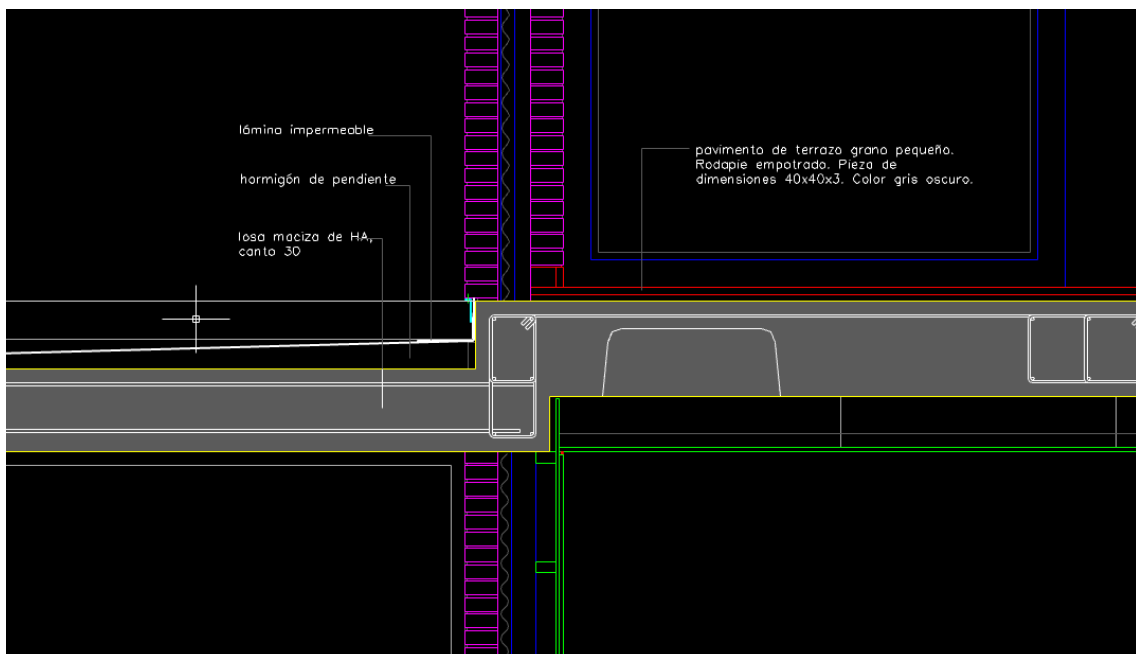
Forjado techo de planta baja, a la derecha cubierta de la zona de circulación
